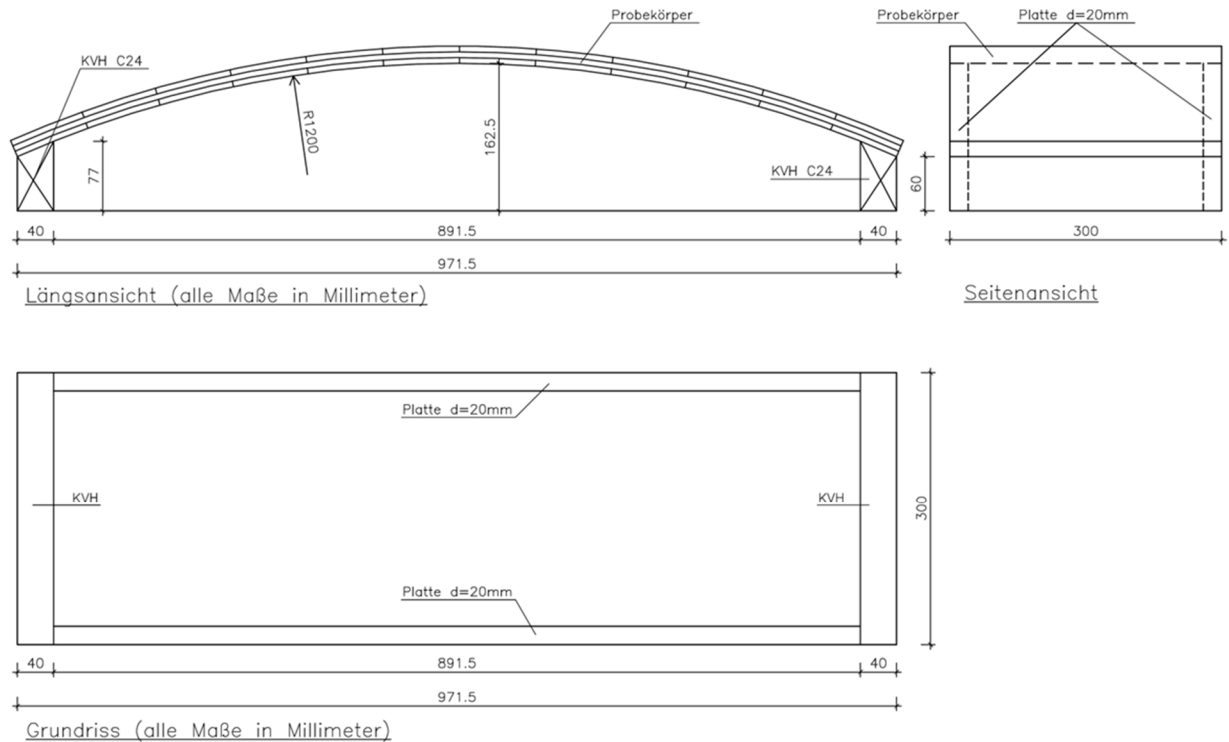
Darstellung des Prüfkörpers in Längsansicht, Grundriss und Seitenansicht
